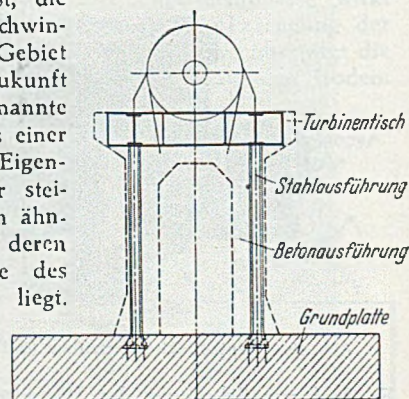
Stahlfundament mit angedeutetem Betonfundament.
